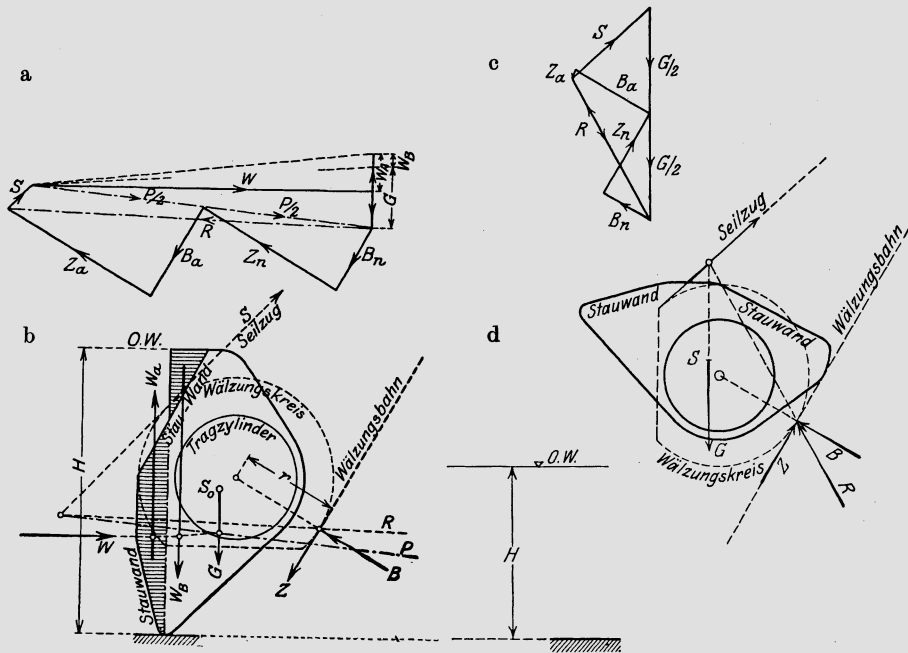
a bis d. Zerlegung der äußeren Kräfte der Walzenauflagerdrücke links vor dem Anheben, rechts auf der Bahn.
